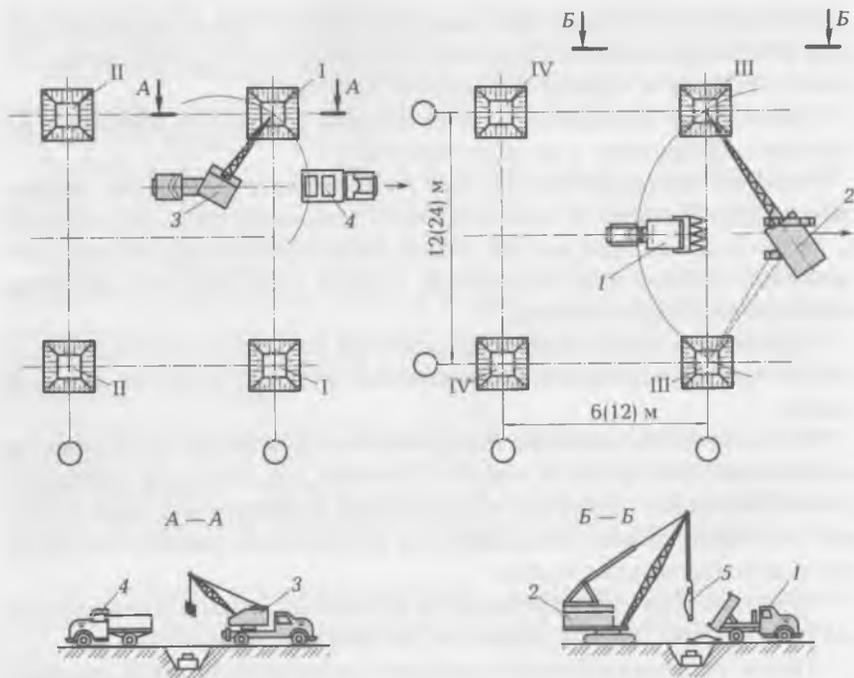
Схема технологического процесса устройства монолитных железобетонных фундаментов с укладкой бетонной смеси с помощью кранов:
